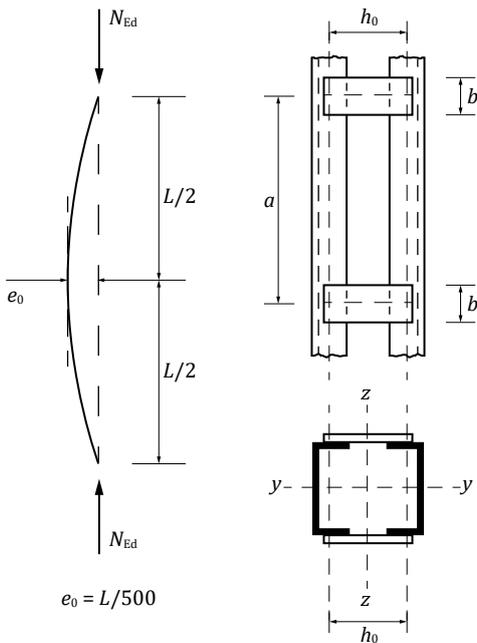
Beispiel für einen Rahmenstab gemäß EC 3 [1], Bild 6.7
